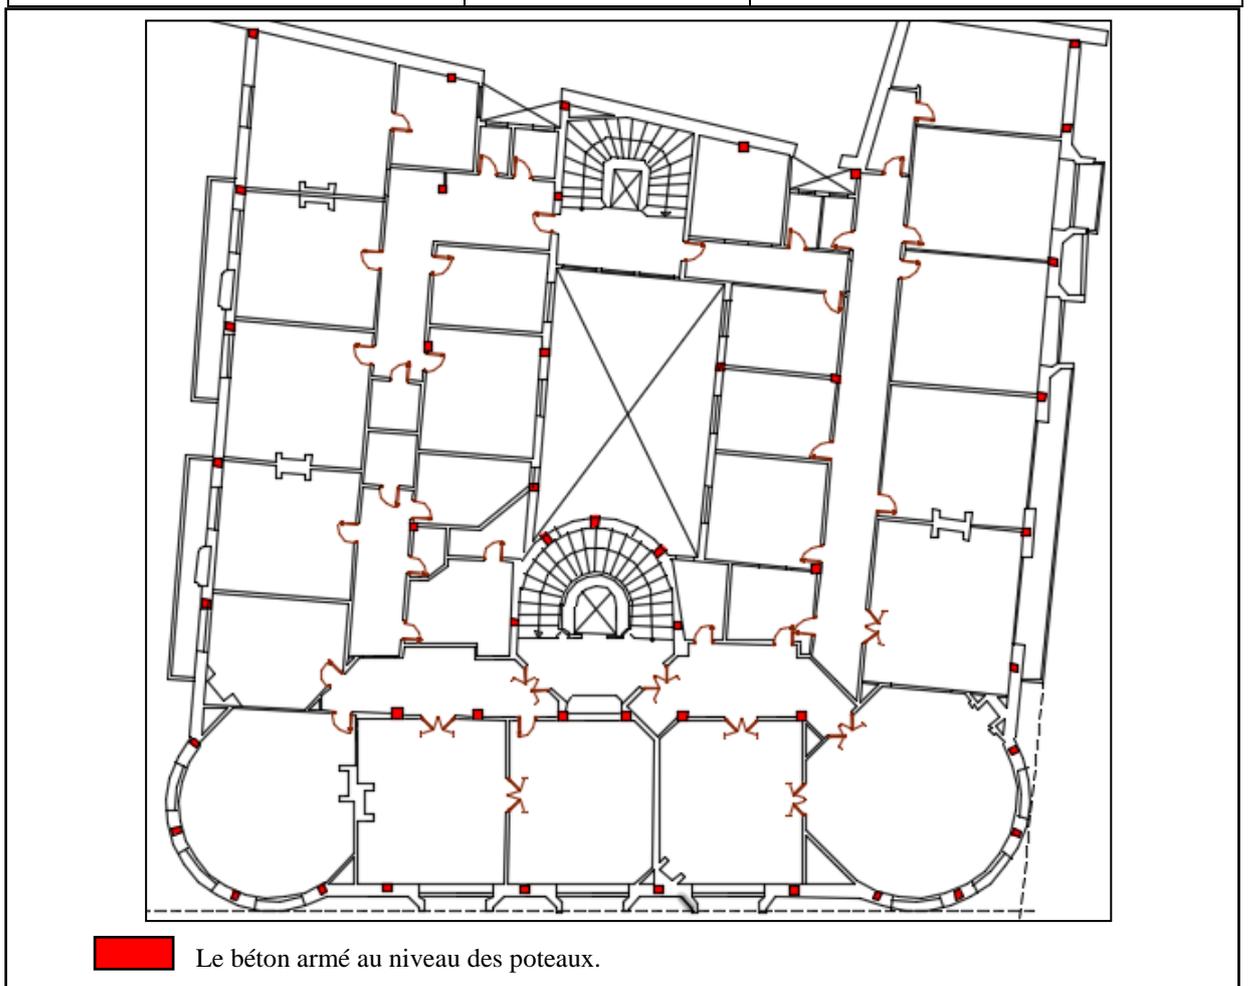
Localisation du béton au niveau du plan. Source : auteur.
